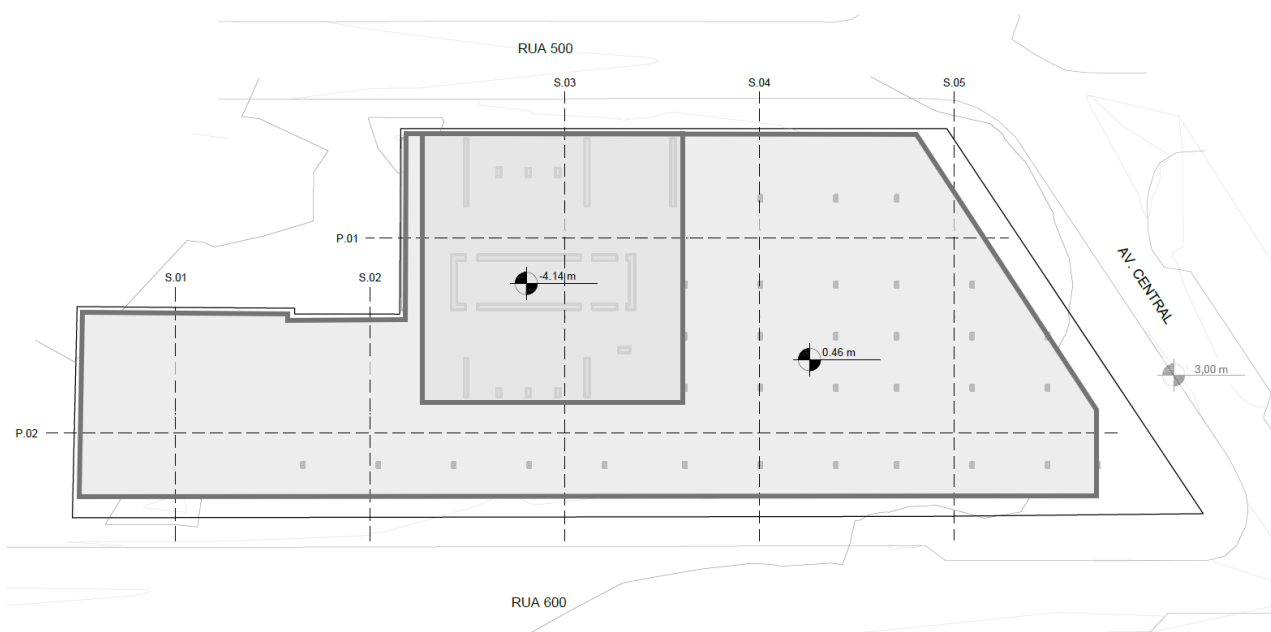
Desenho em planta com estimativa das implantações do subsolo e bloco central de fundação.
